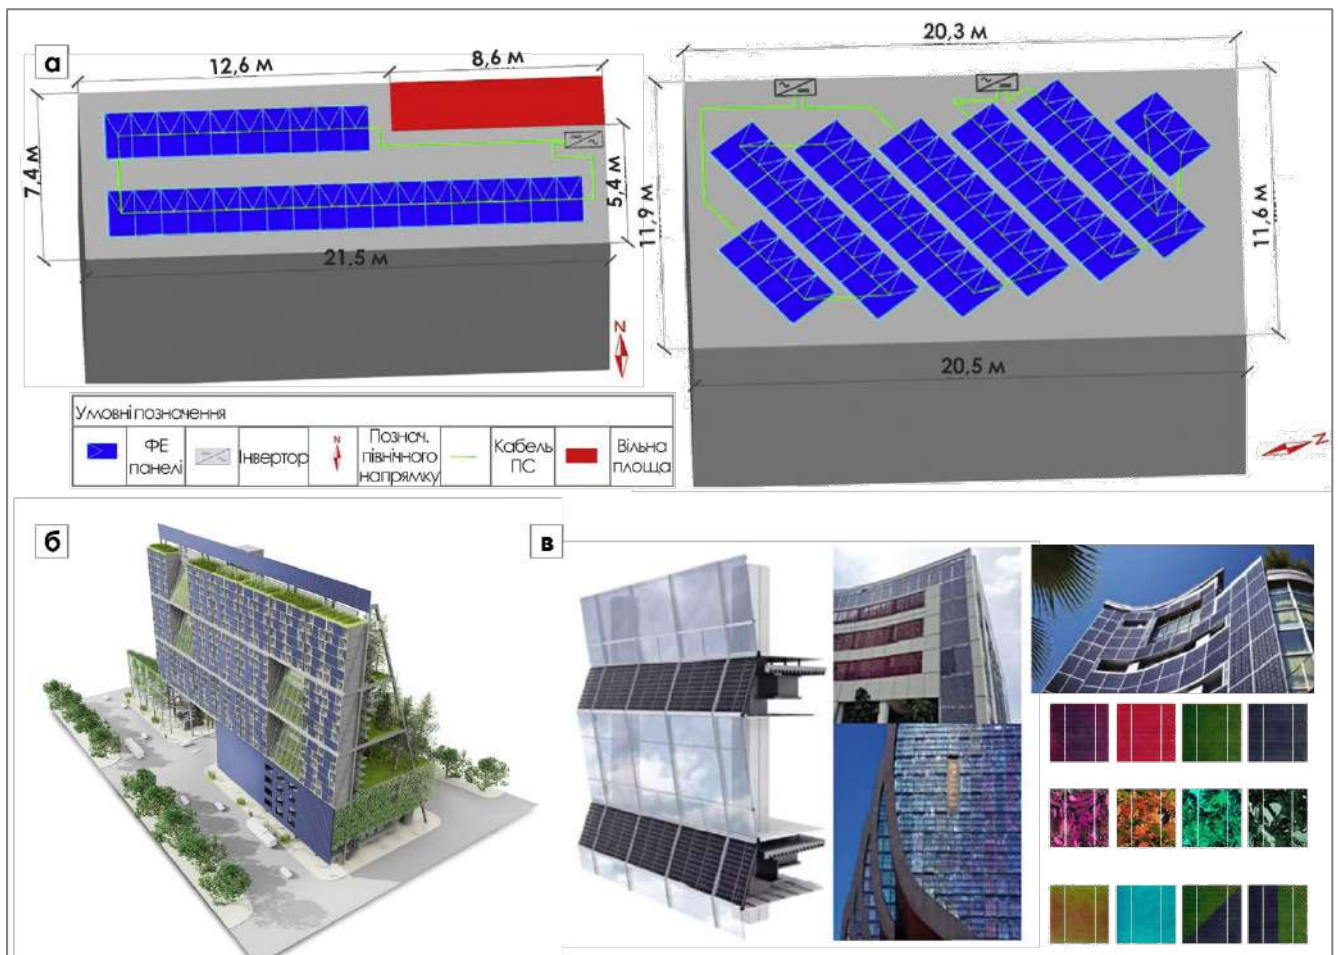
Схеми розташування ФЕП: а) на даху споруди вертикального господарства у дослідженні Й. Л. Тео, Китай [227]; б) у структурі фасаду на прикладі будівлі багатофункціональної ферми [228]; в) у структурі фасаду на прикладах різних систем [229].
